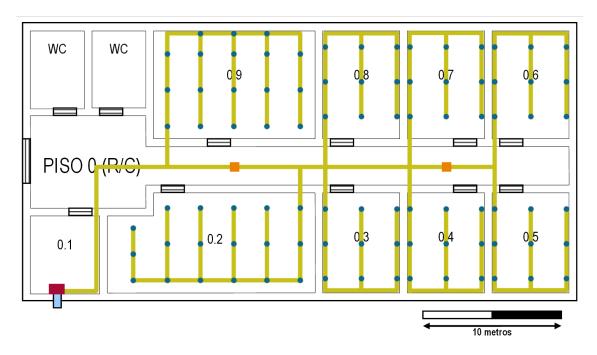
Planta dos edifícios ED.5, ED.6 e ED.7 preenchida com a disposição das tomadas de rede, pontos de acesso, distribuidor de piso e cablagem (Imagem 2).
